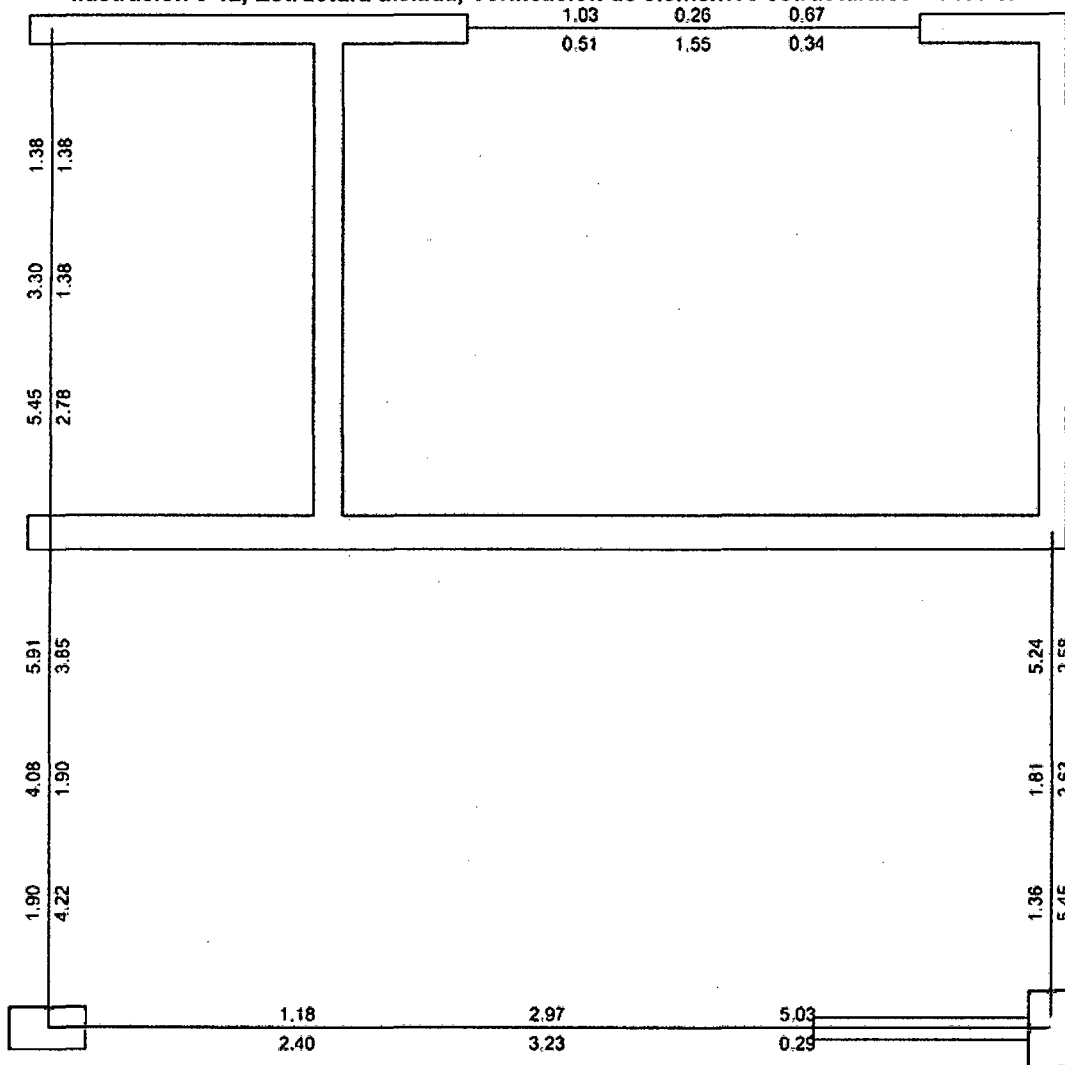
, Estructura aislada, Verificación de elementos estructurales – Piso 5.
